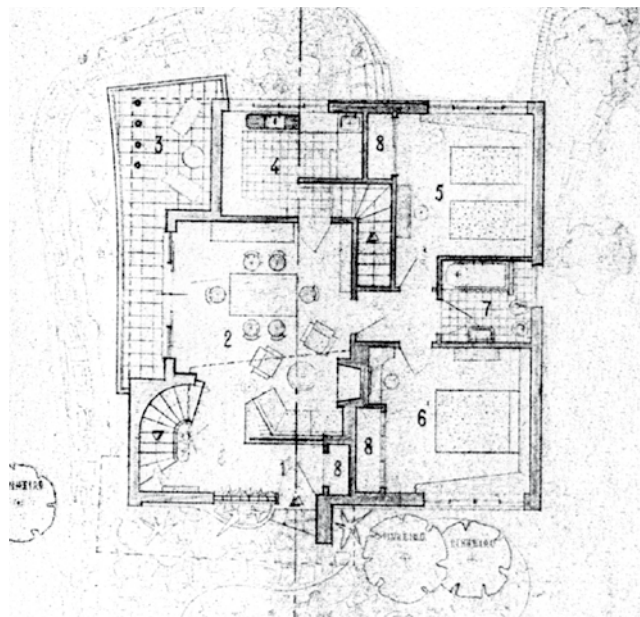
Casa Floriano Silva, António Baroseiro, 1952. Planta piso 0.
